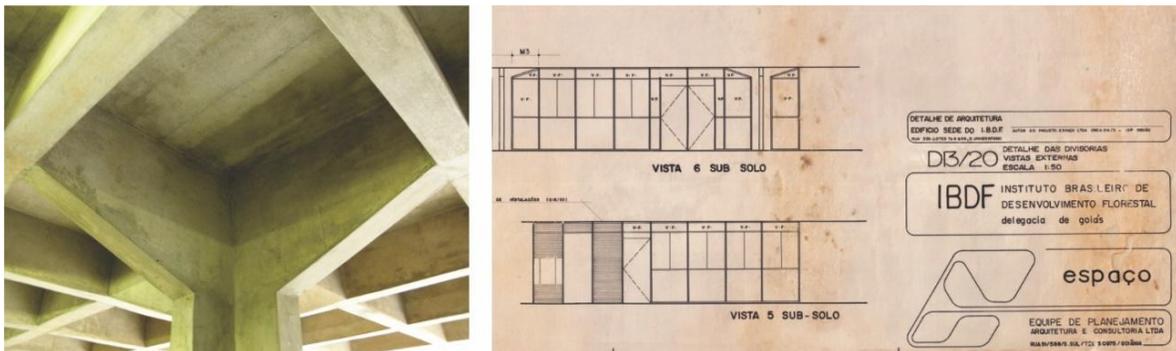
Plantas de localização e fachadas do edifício sede do IBDF
